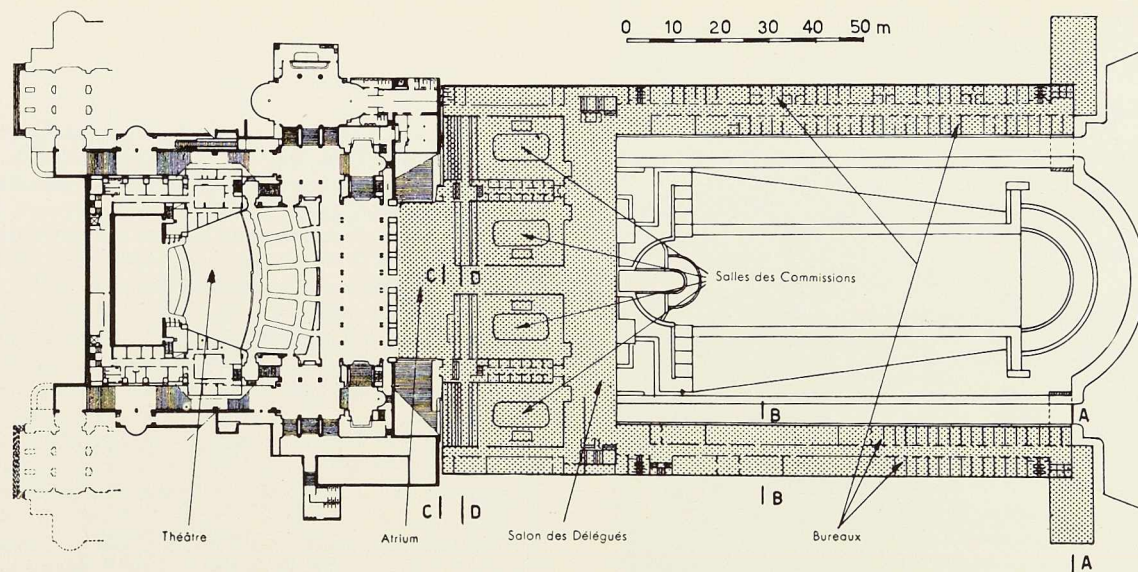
Plan général du nouveau Bâtiment de l'O. N. U. Le grisé représente la nouvelle construction raccordée au Palais de Chaillot. (Niveau 4,05 m.)
